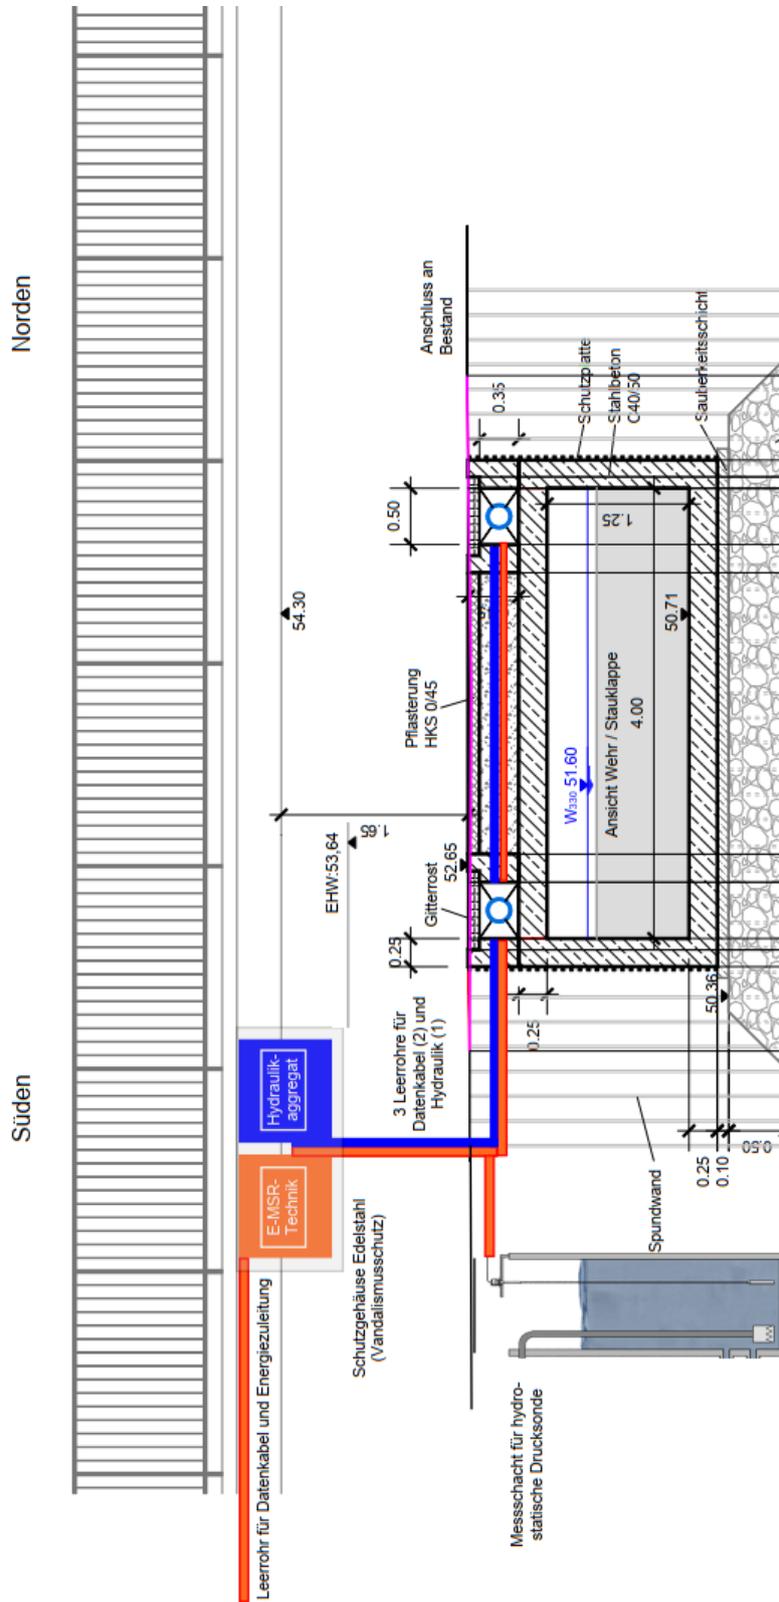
Grundaufbau der technischen Ausrüstung am Überleitungsbauwerk
